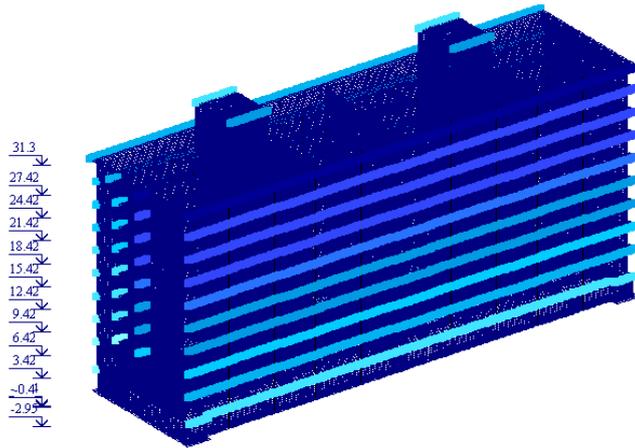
Ветровая нагрузка на фасад в осях 1-15
